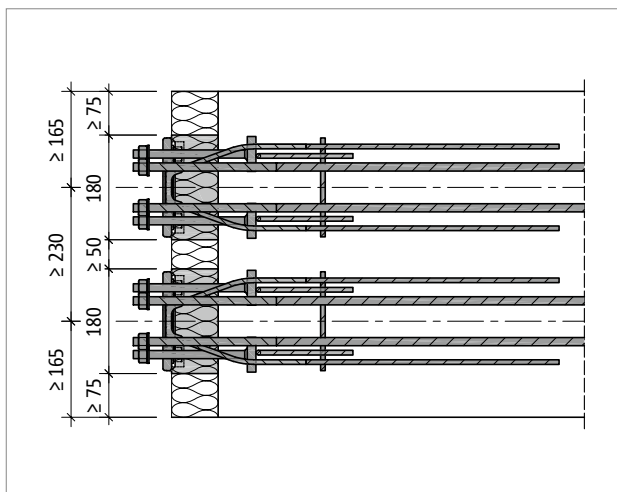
Schöck Isokorb® T type SK : espacement axial
